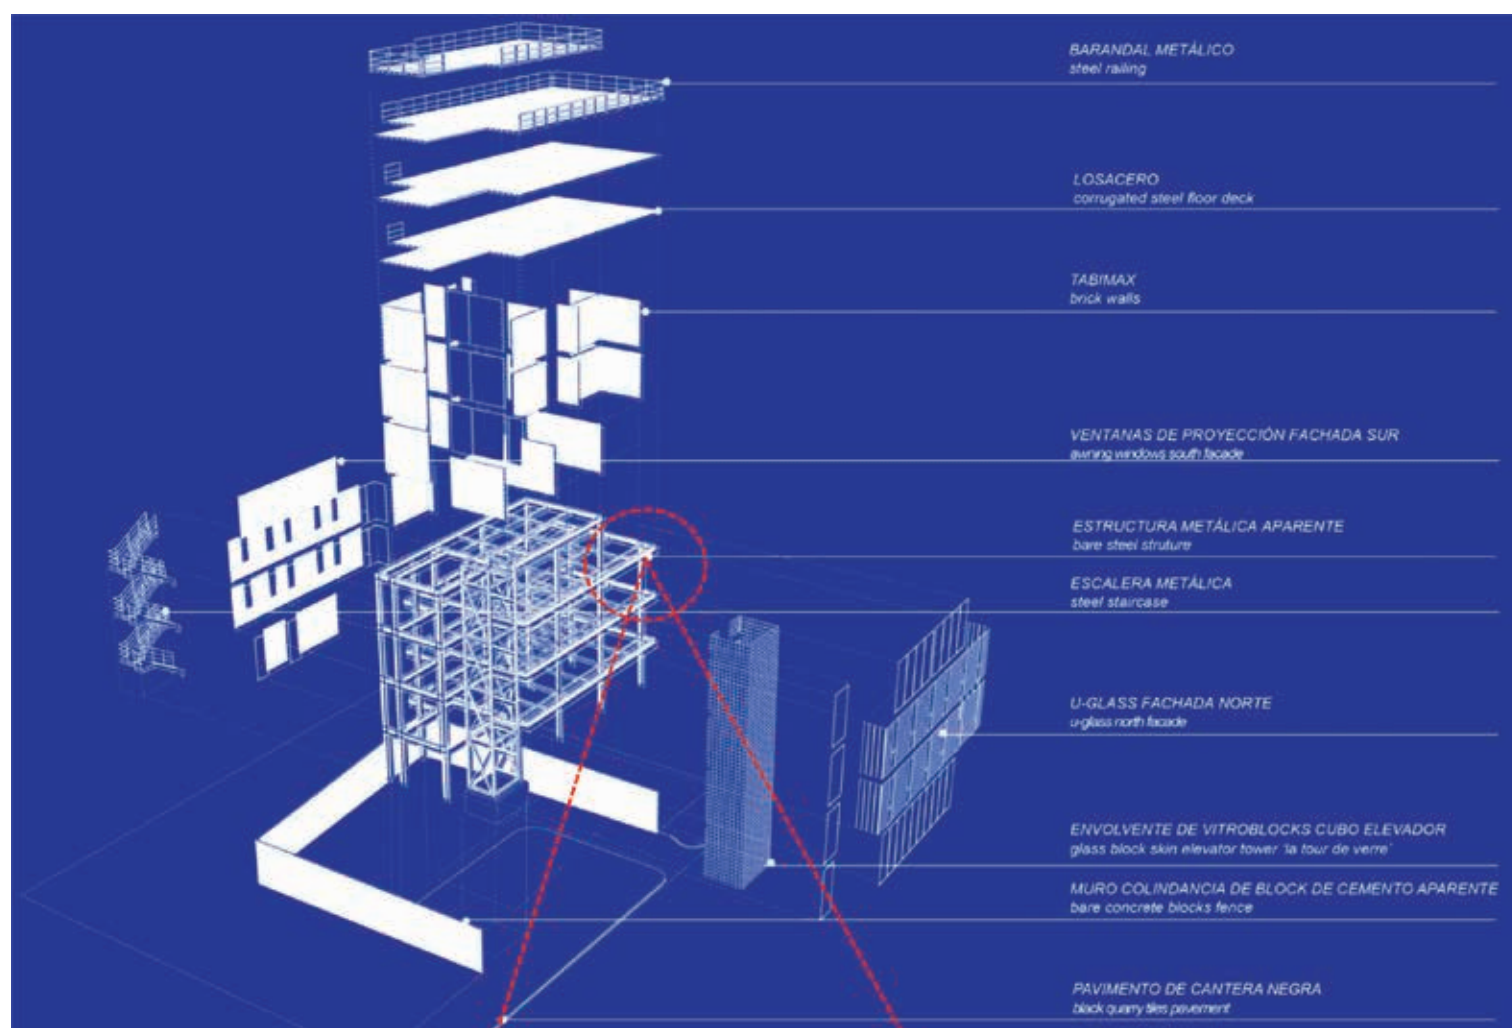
| Struttura di elevazione verticale (pilastri) ed orizzontale (travi) del Centro dermatológico Avenida Central Building (fonte: Emilio Alvarez Abouchard Arquitectura)
